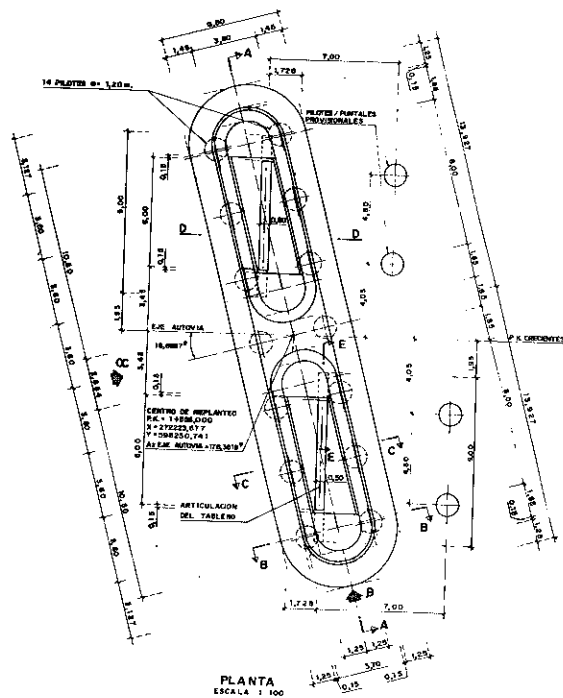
Plano detalle de la Pila - Péndolo - (Planta).
